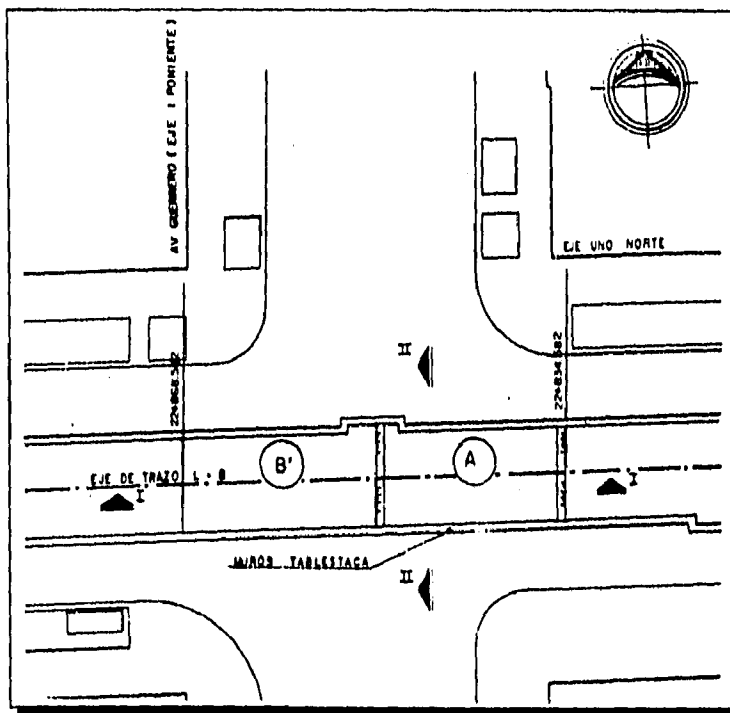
Planta de etapas de excavación, correspondiente a la 1ª fase del tuneleo.
